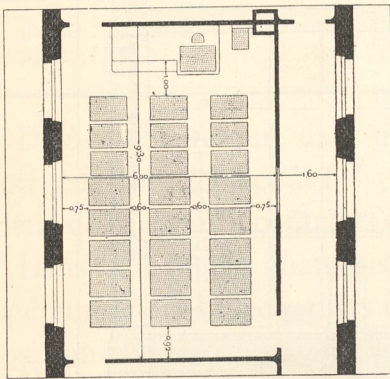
Plan d'une classe à éclairage unilatéral.
